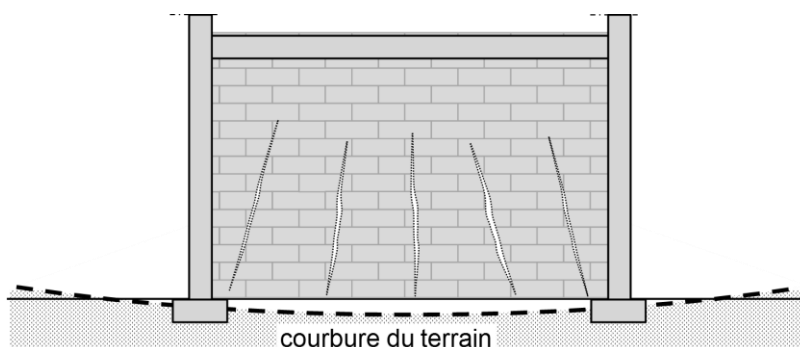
exemple de fissures verticales et diagonales induites par la courbure du terrain
